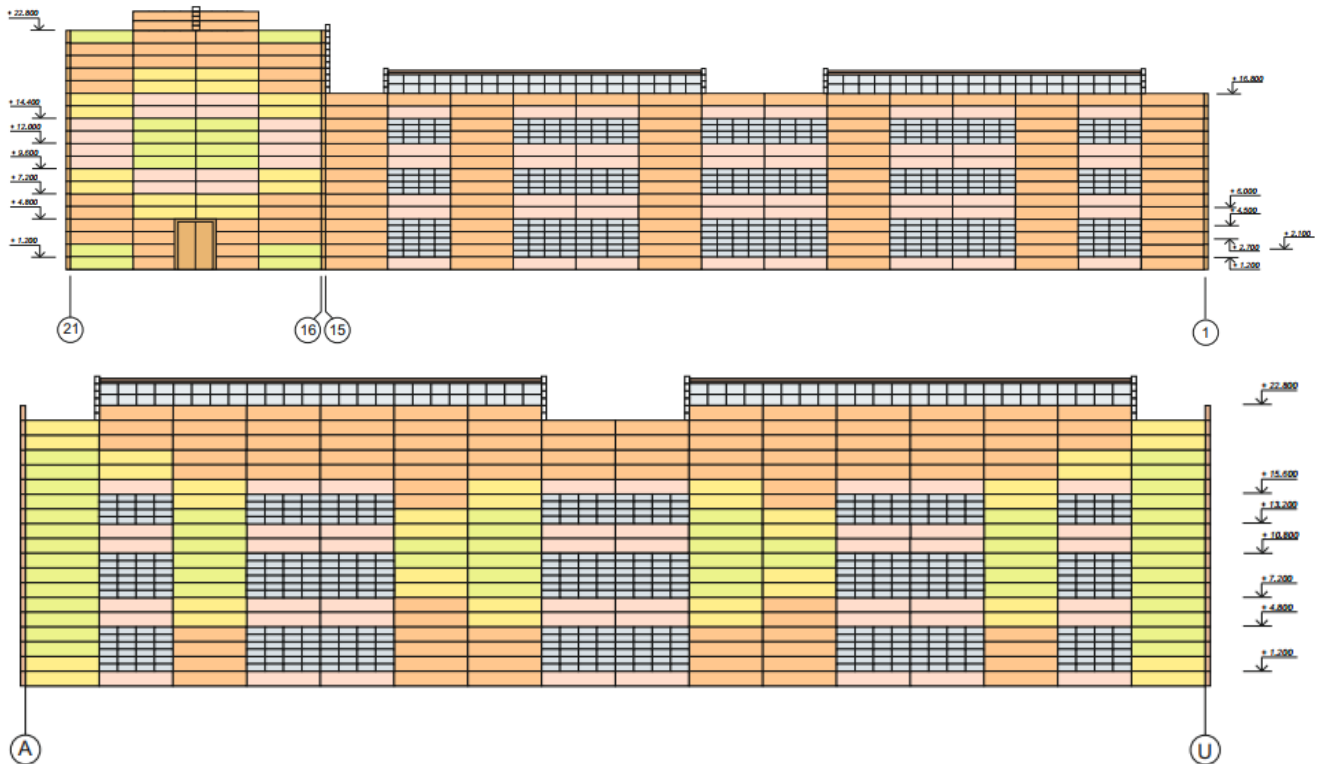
Схеми розташування стінових панелей по фасадам
